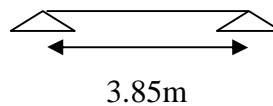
Schéma statique du 3<sup>ème</sup> type de poutrelles.
